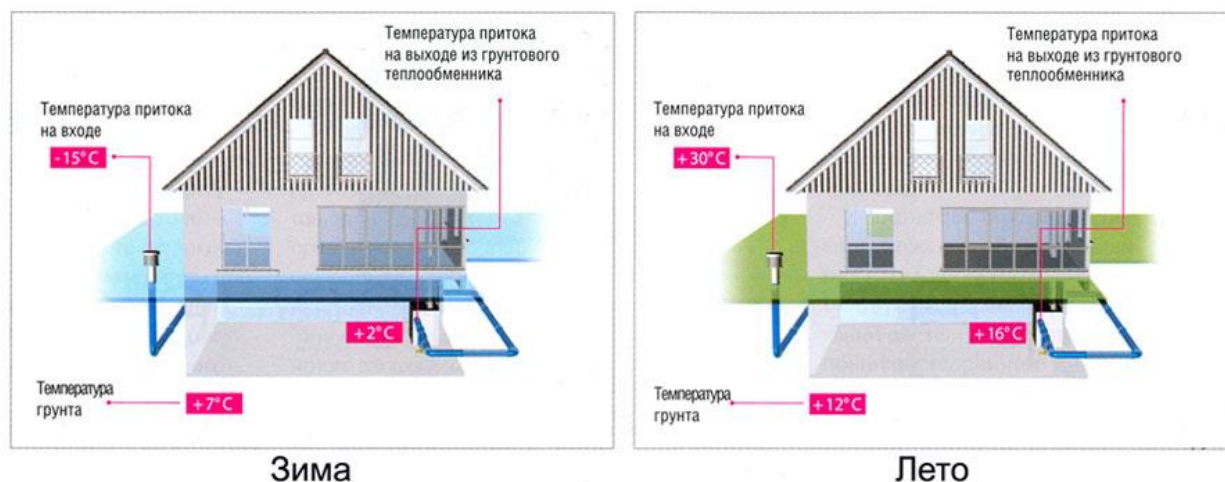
Принципиальная схема геотермальной вентиляции
